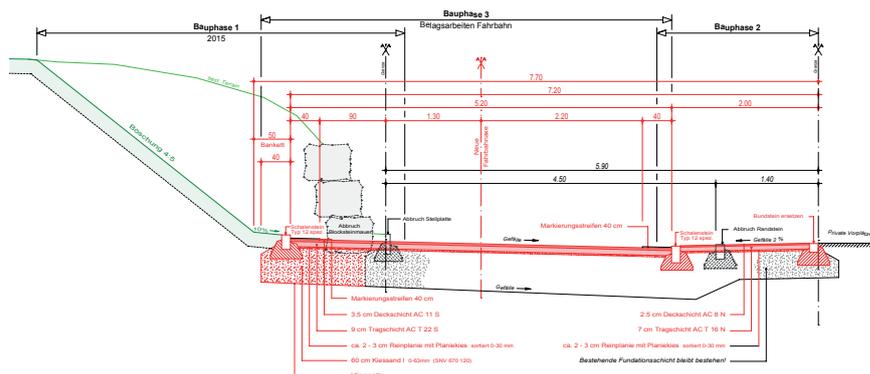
Endausbau Striegelgasse (Quelle: Bruno Stocker Bauingenieur AG)
